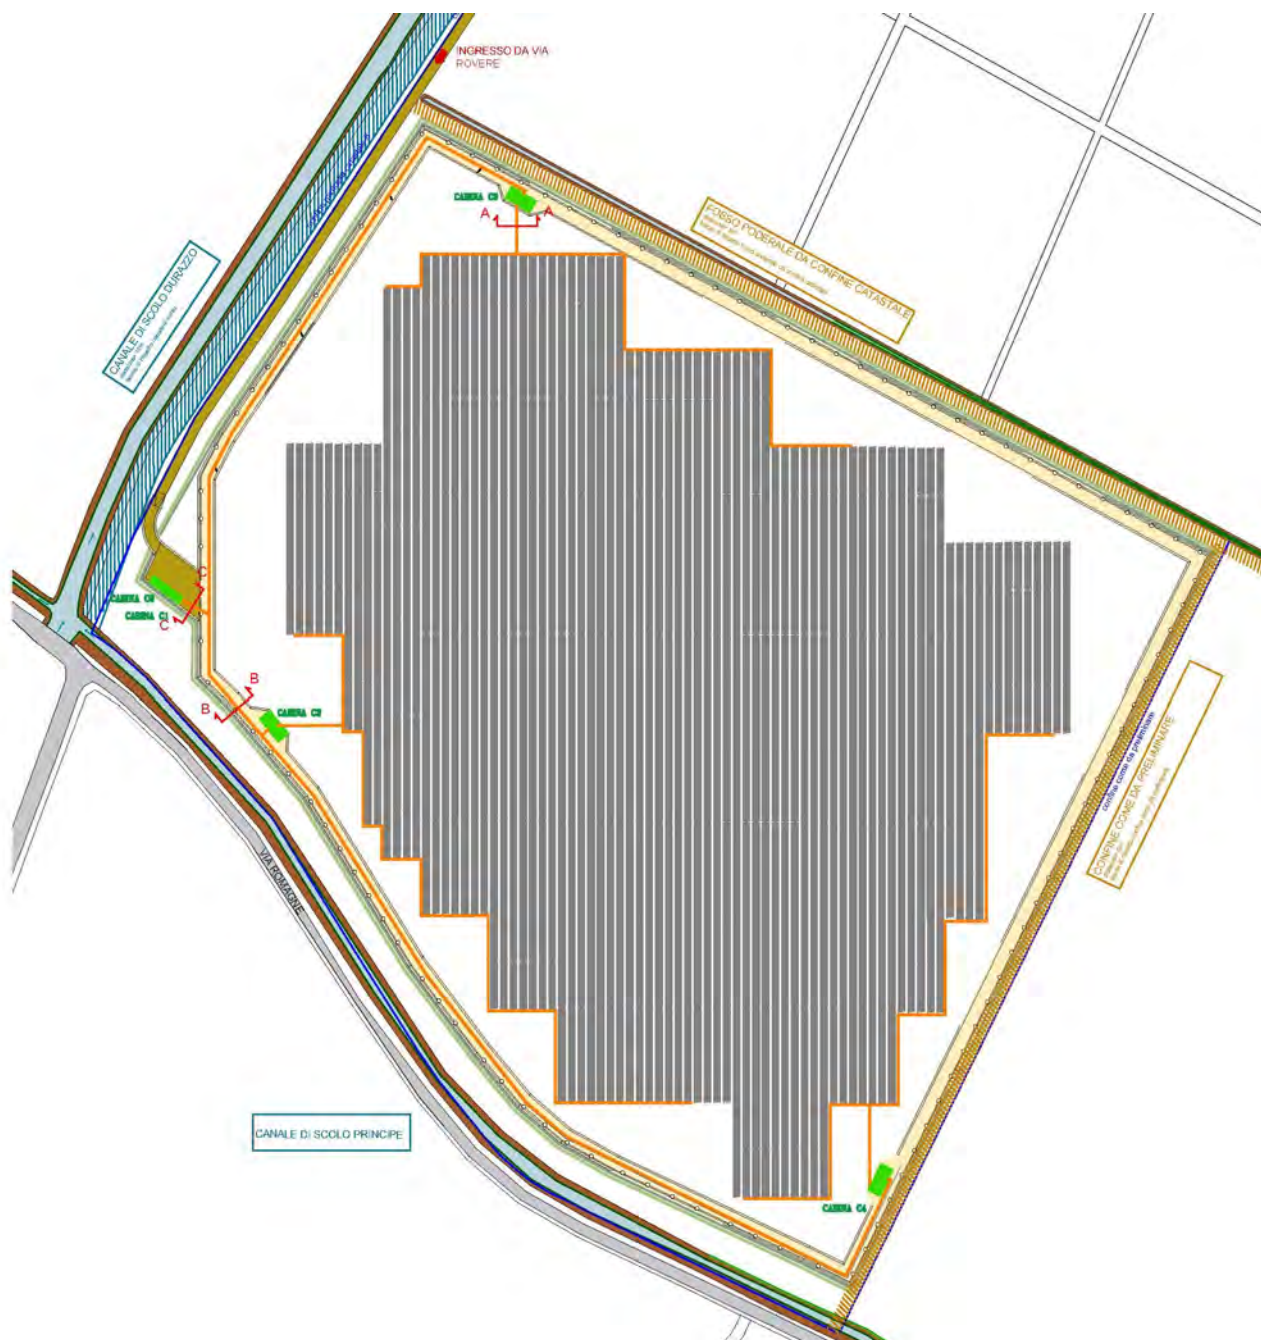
Planimetria degli scavi; in arancione le linee elettriche, in verde le cabine di campo
